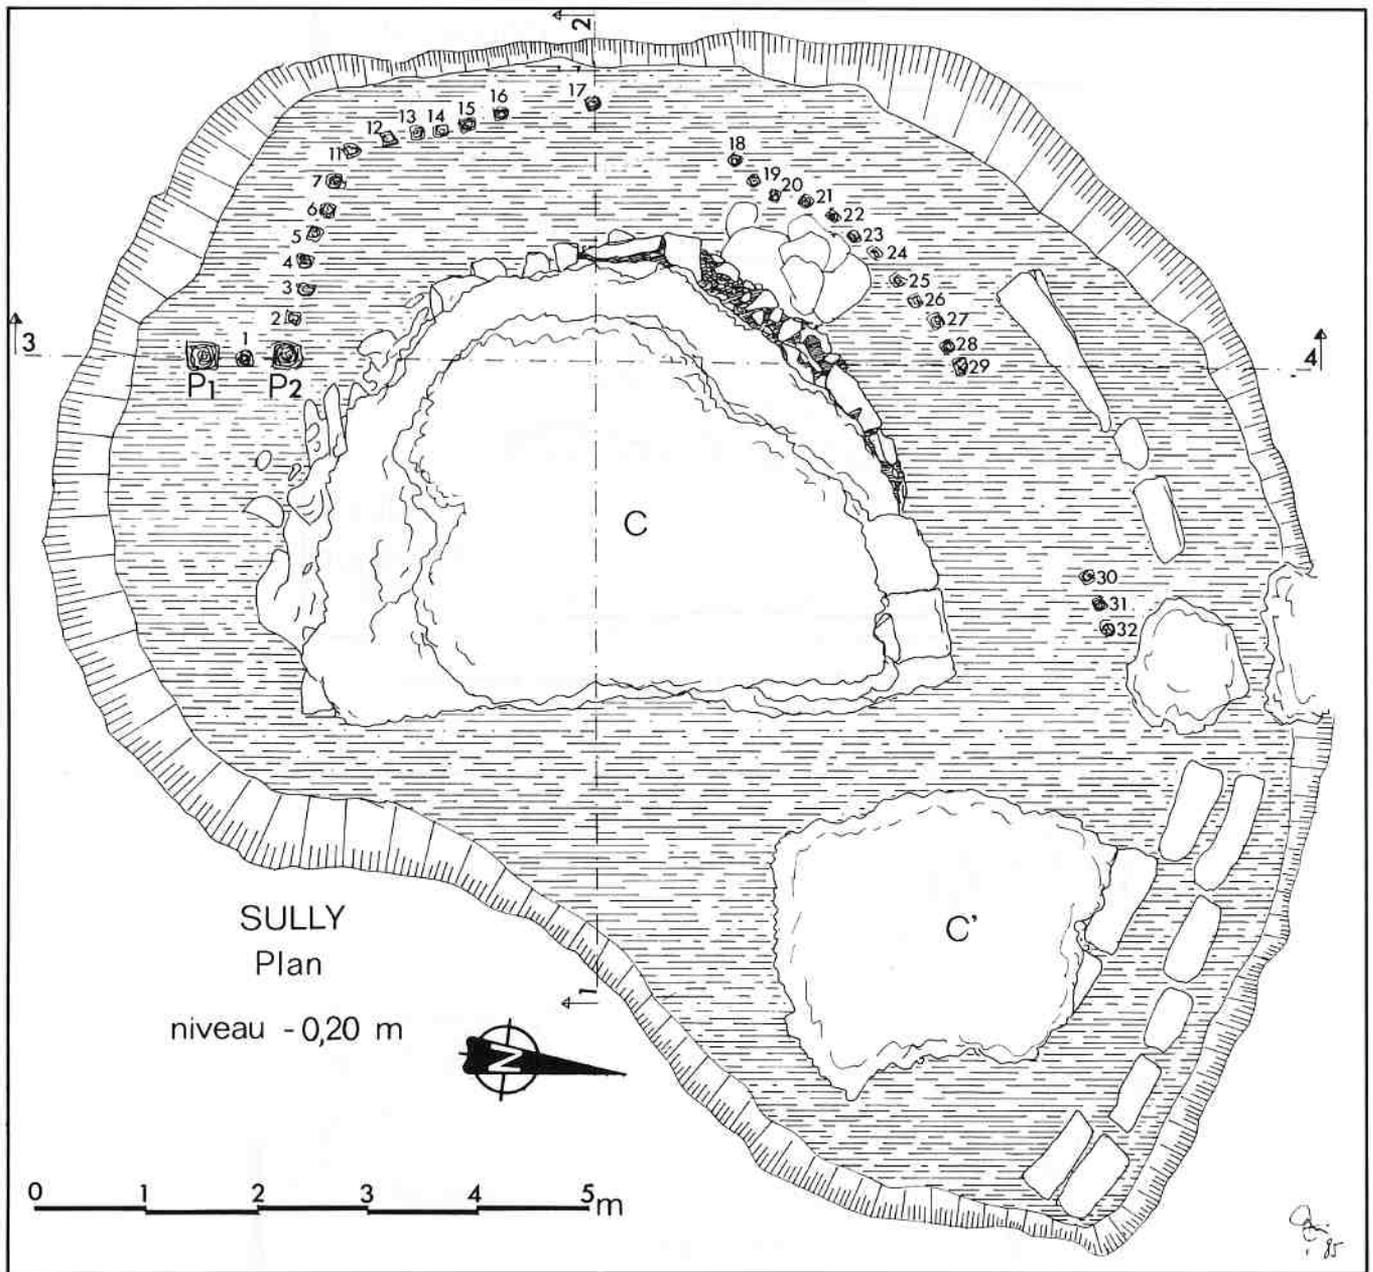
Sully-sur-Loire. Pile C du pont médiéval : plan des structures.
